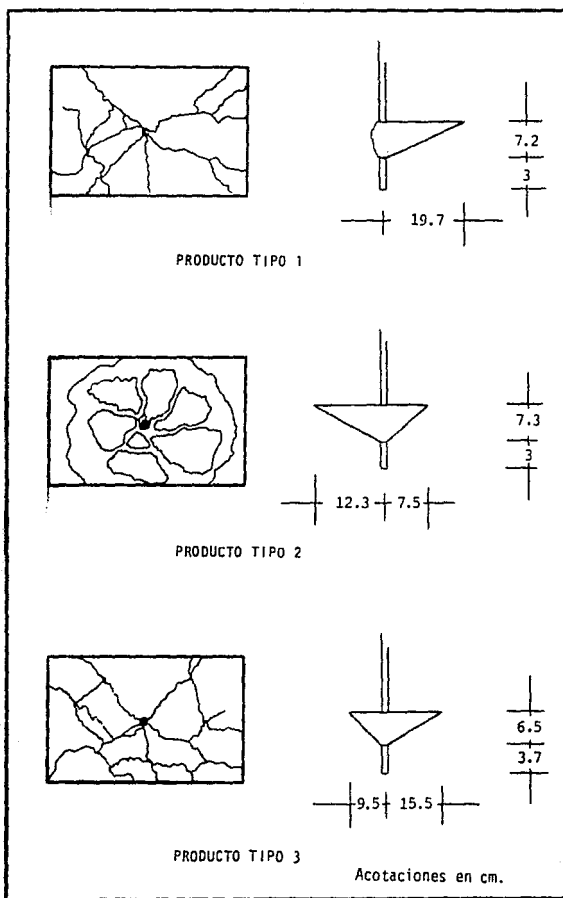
Configuración de los modos de falla de varillas ancladas en concreto reforzado bajo carga alternada
